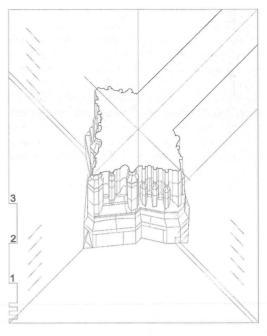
Axonometría del pilar entre capillas del lado sur. (Dibujo del autor)
